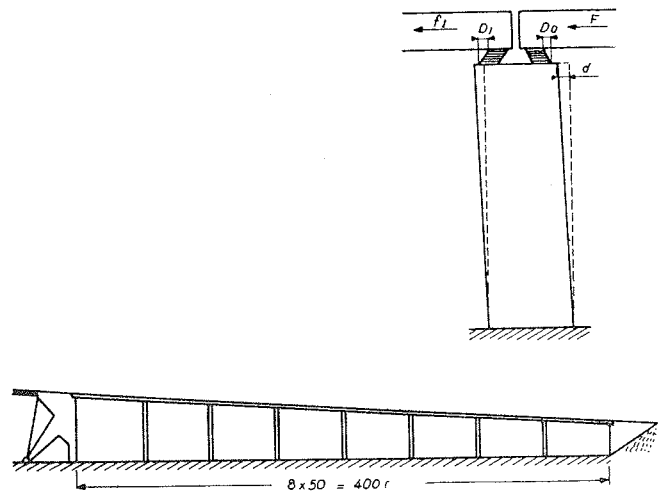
Empleo de apoyos tipo S. T. U. P. en los tramos de acceso.
